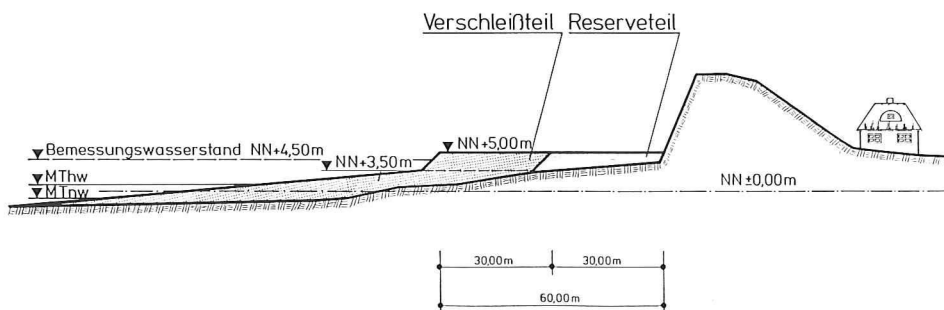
Regelprofil einer Sandvorspülung vor einer Abbruchküste (schematisch) (Quelle: FACHPLAN SYLT 1985 des ALW HUSUM)
